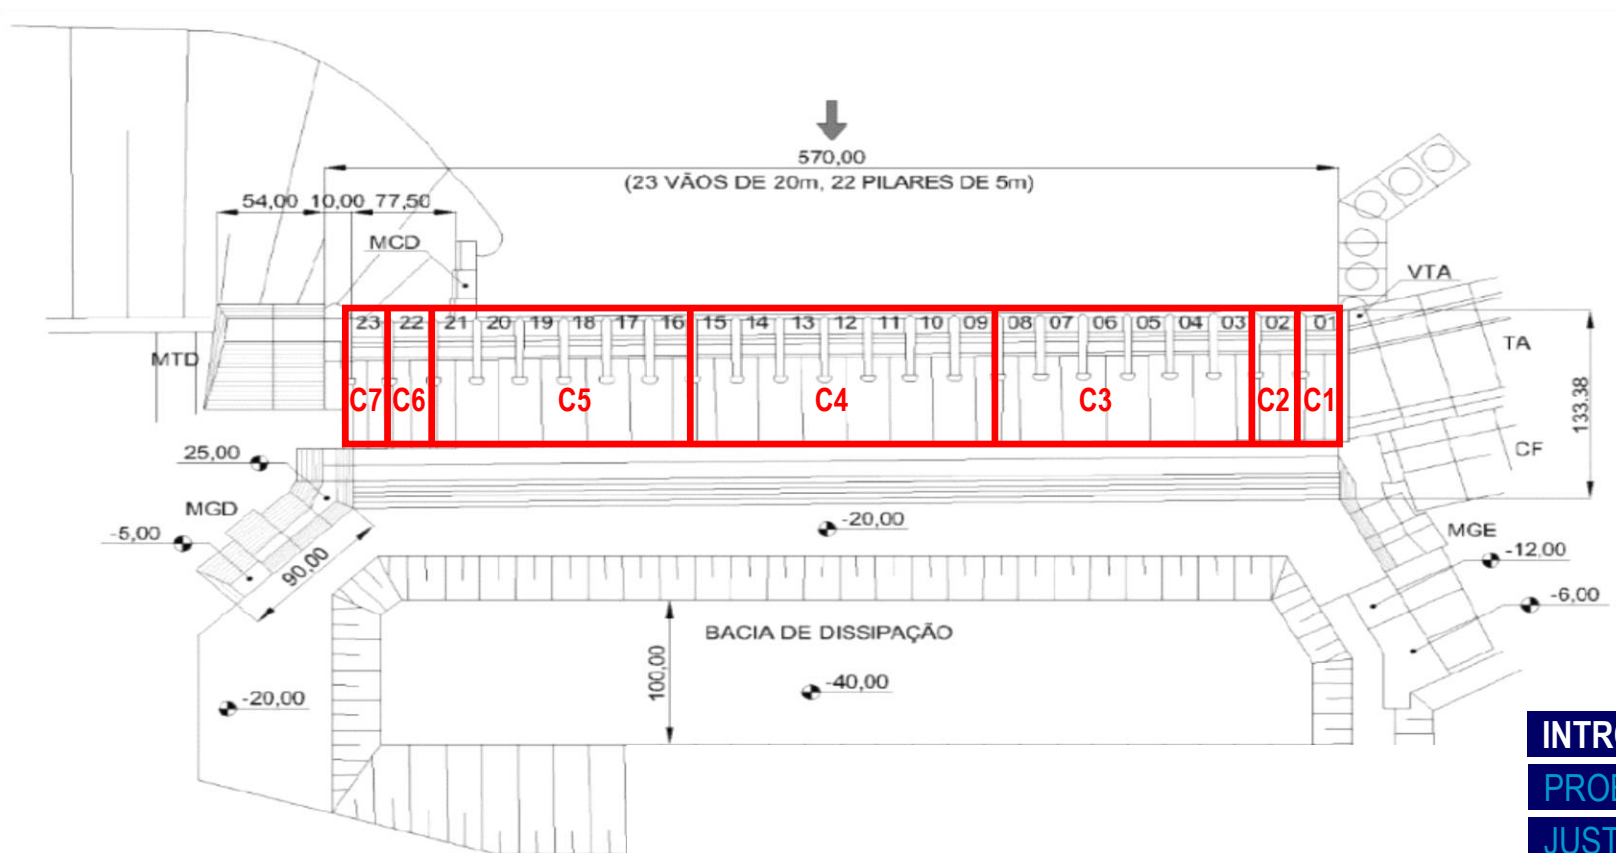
Planta Baixa do Vertedouro da UHE Tucuruí
